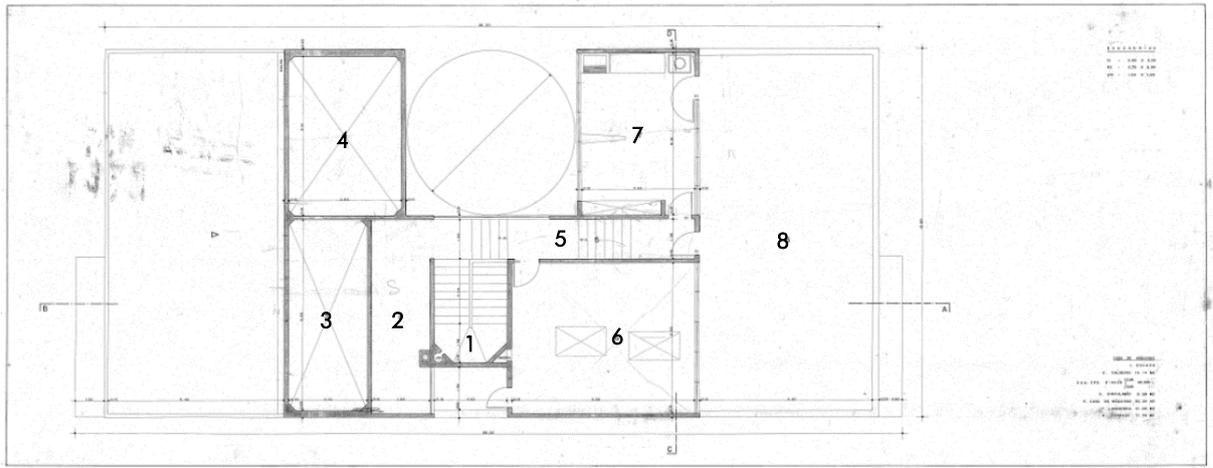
Planta-baixa pavimento cobertura. Programa: 1. Escada; 2. Caldeira; 3/4. Caixas D'água; 5. Circulação; 6. Casa de Máquinas; 7. Lavandeira; 8. Terraço.
